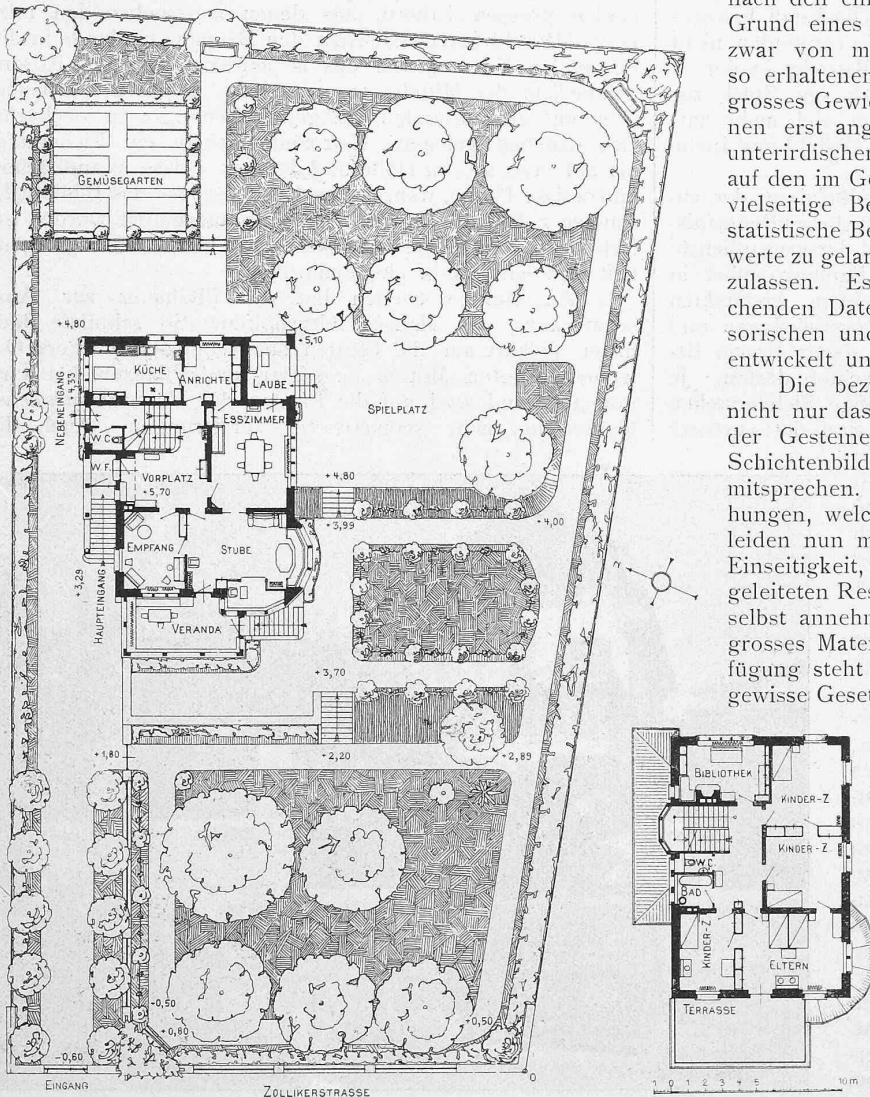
u. 3. Grundrisse vom Erdgeschoss und ersten Obergeschoss sowie Lageplan des Gartens.
